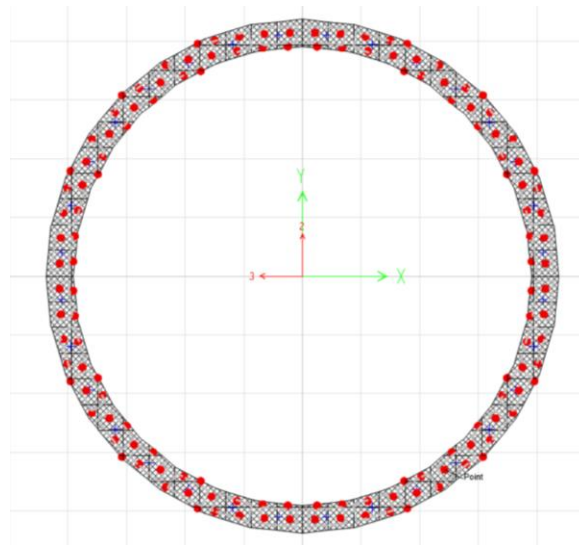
Modelado de la sección del cuerpo del fonil en *Section Designer
